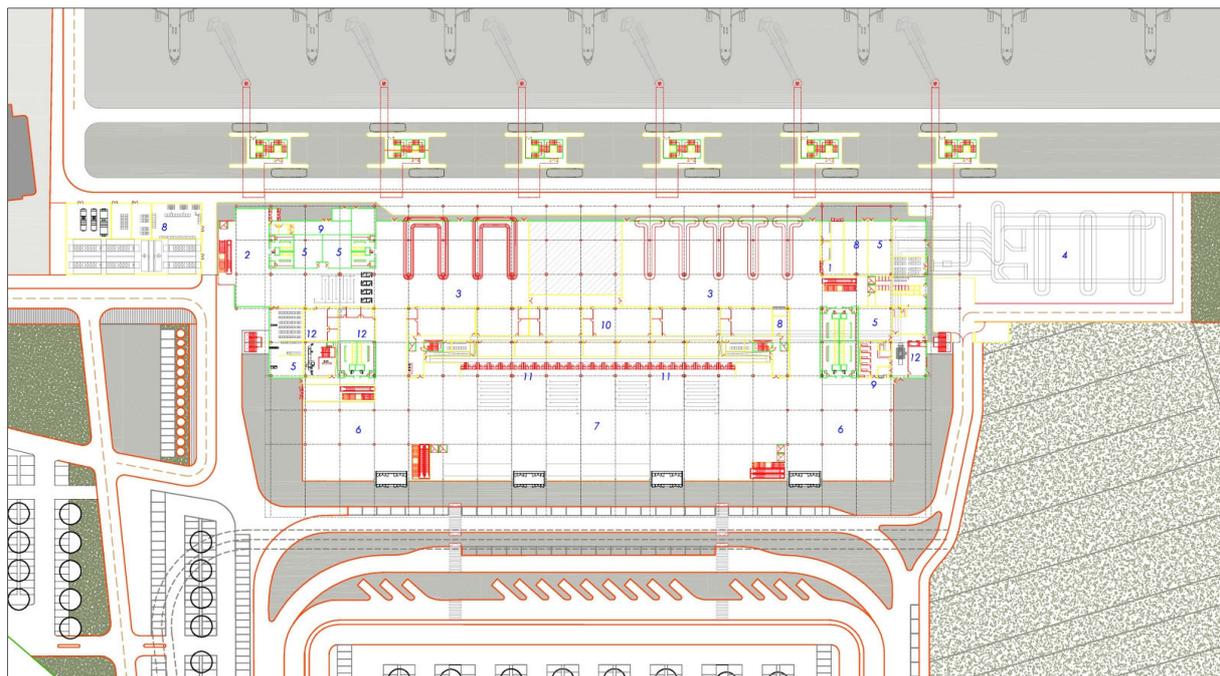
NUOVO TERMINAL – Pianta piano terra scala originale 1/500
